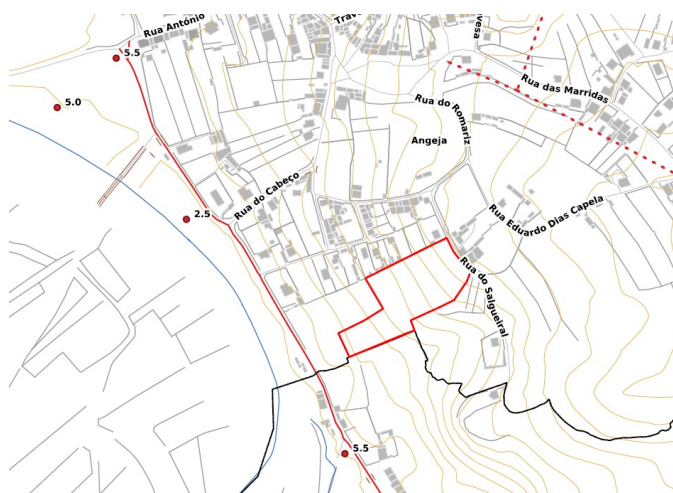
Planta de localização – Rua do Salgueiral - Angeja
